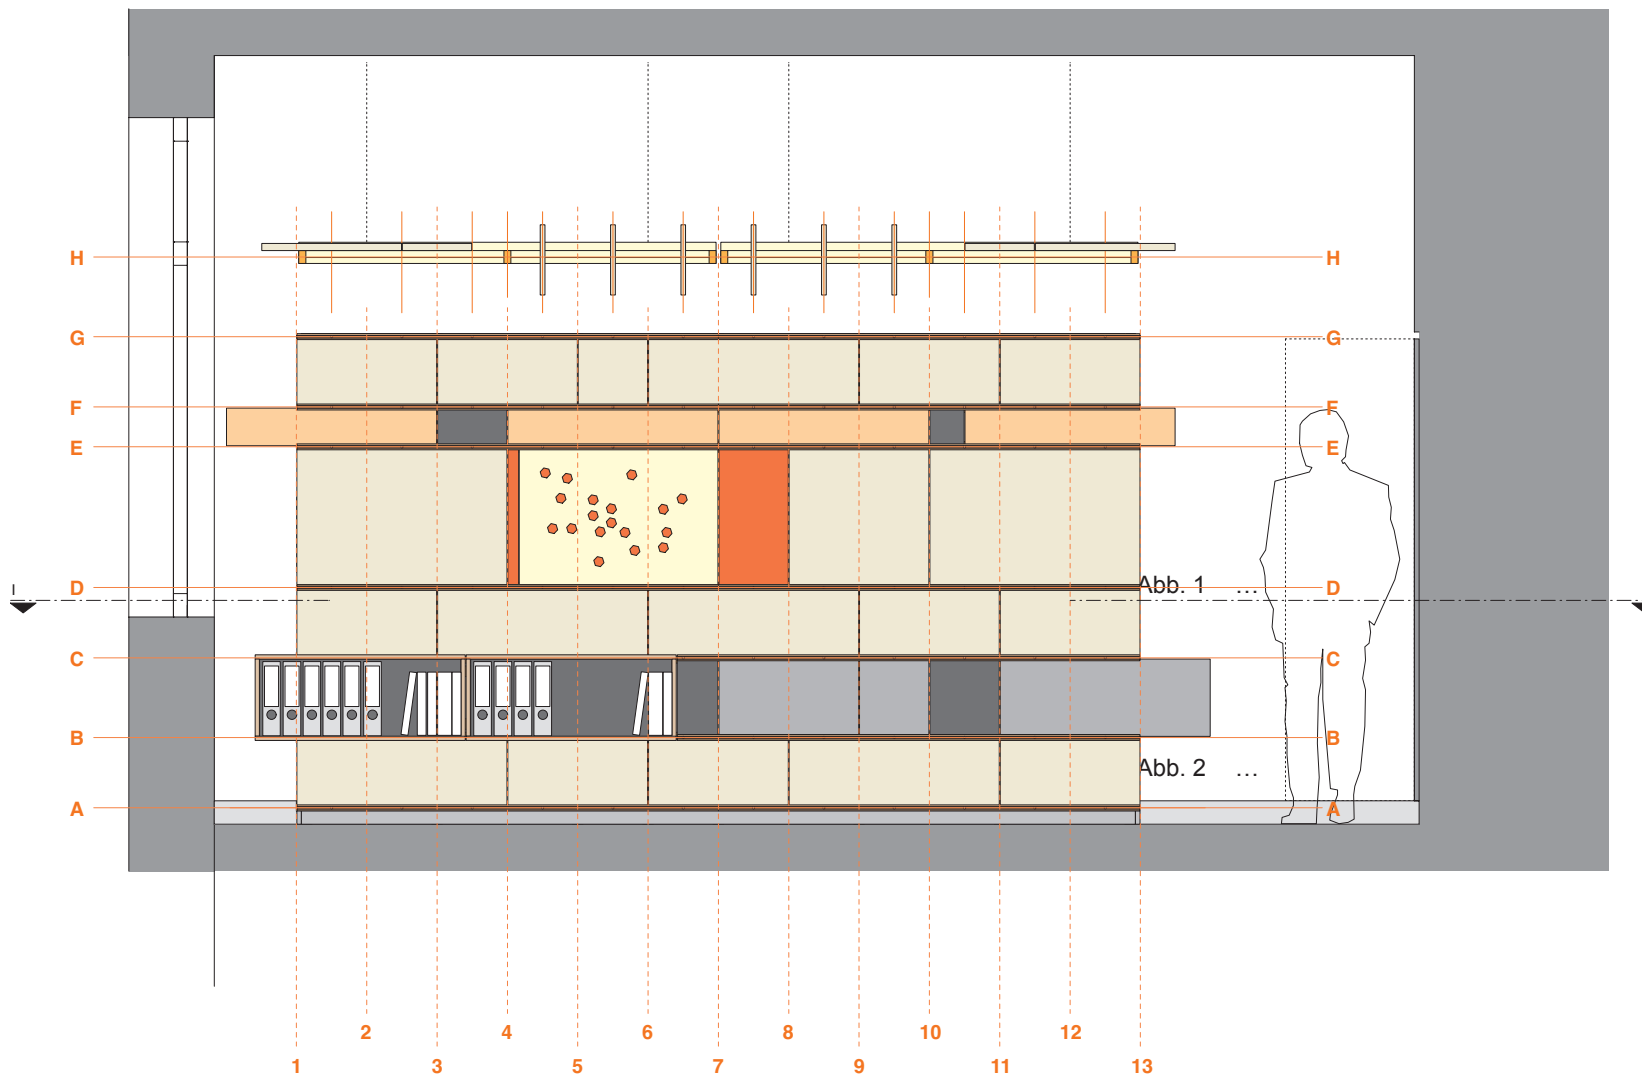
Längsschnitt durch den Raum mit Ansicht Wandfläche und Deckenelement M 1:30
